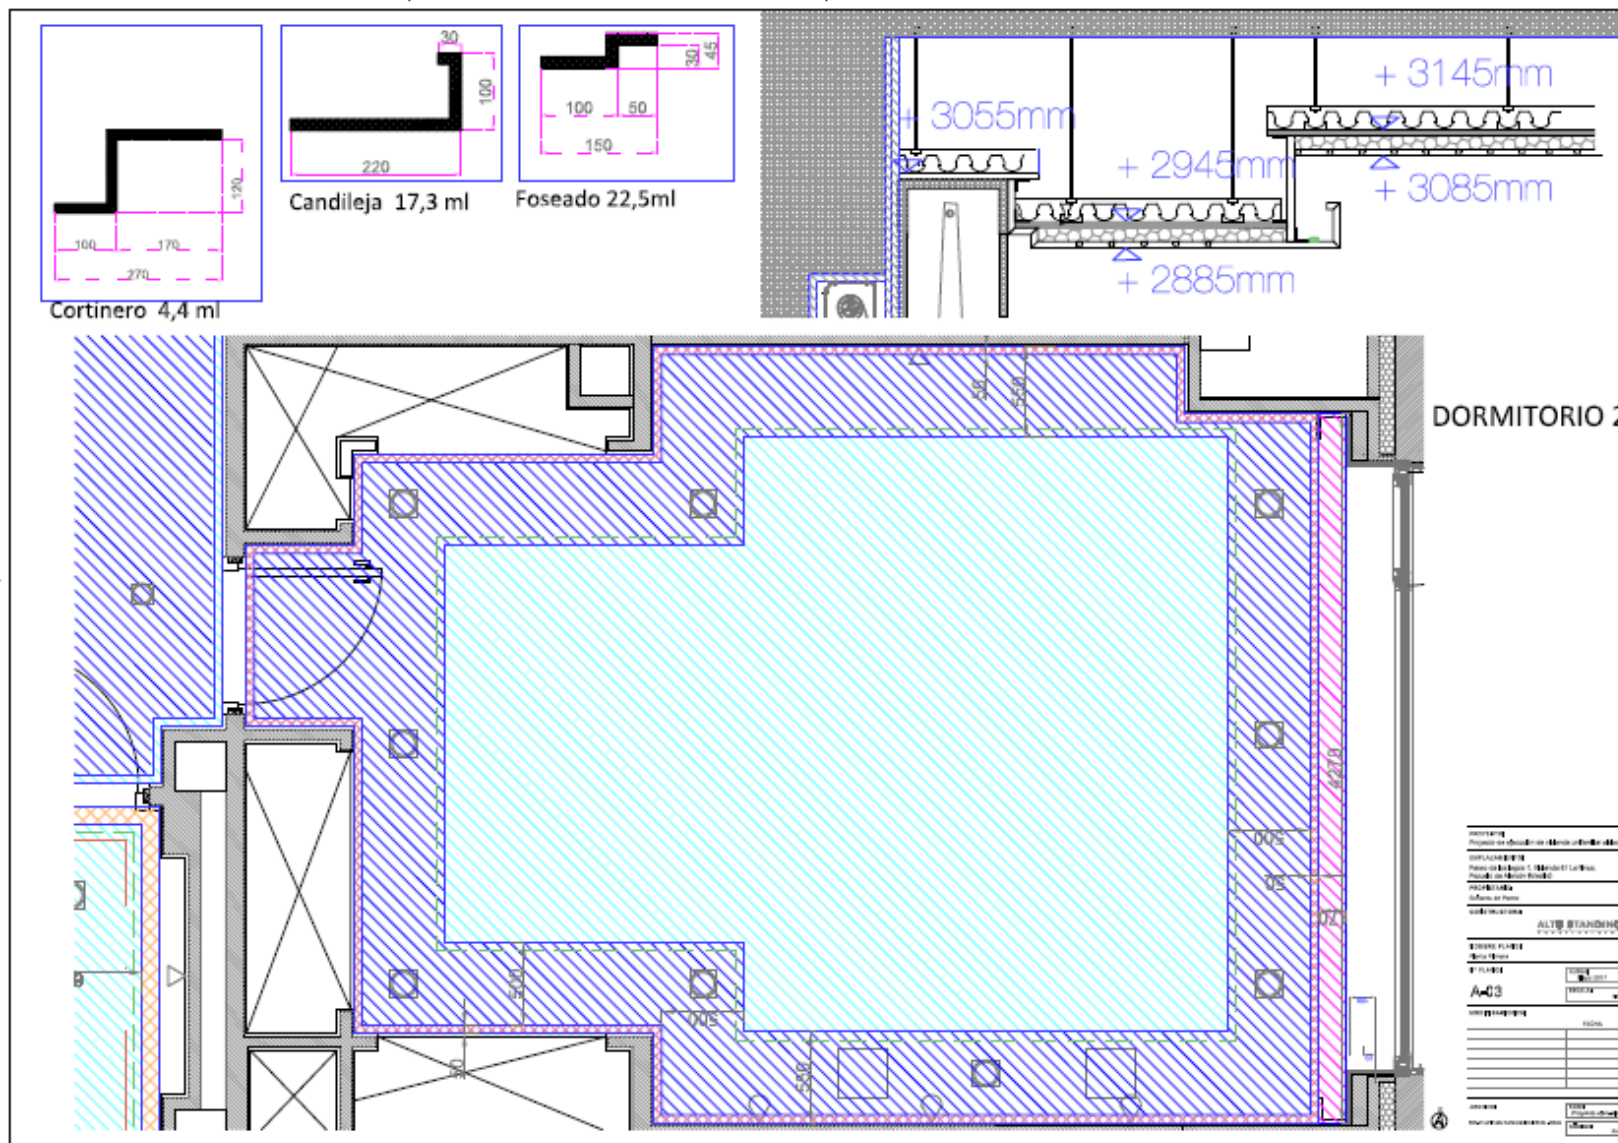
Plano de falso techo del dormitorio infantil en planta primera. de la vivienda objeto. Fuente: Elaboracion Propia
